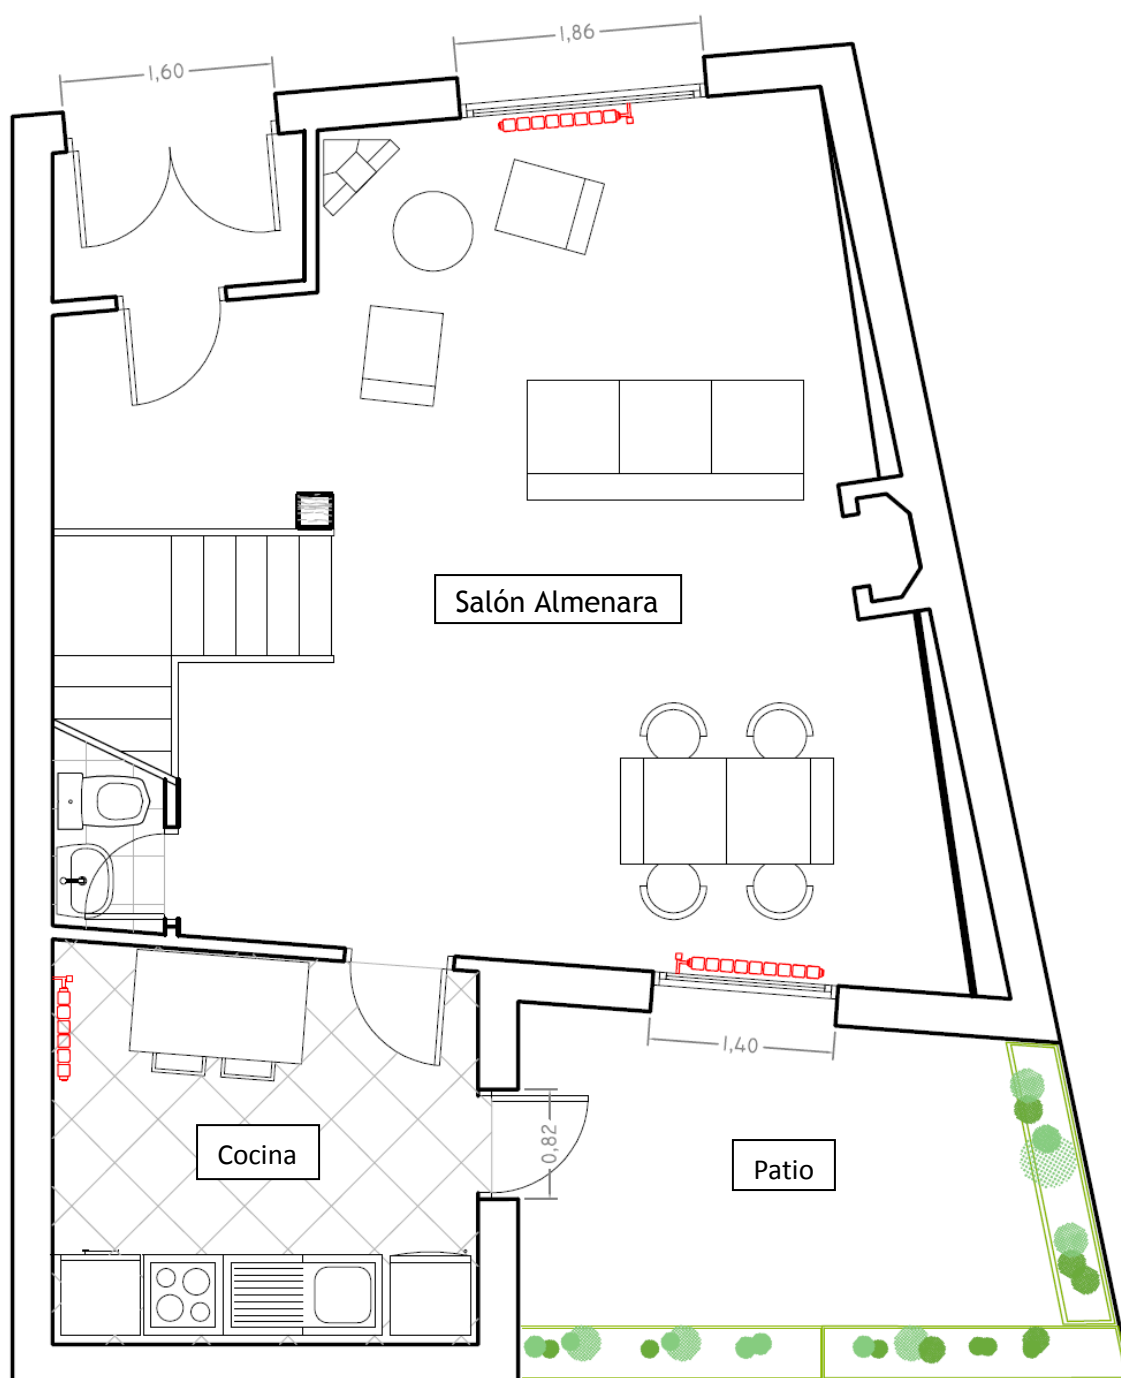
Cotas de las ventanas de la planta baja (Escala 1:50).
